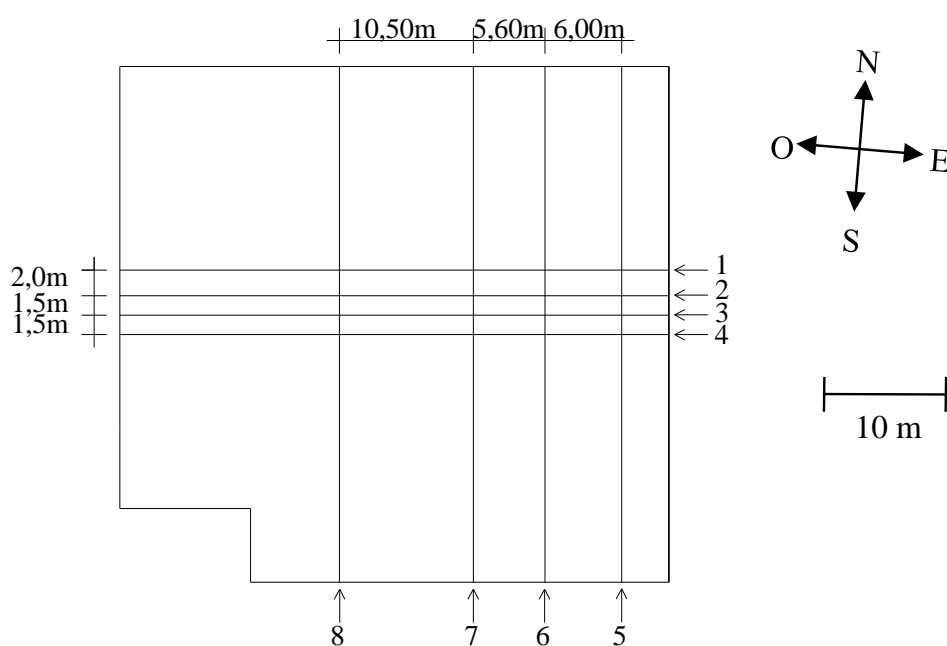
Localização perfis transversais (1 a 4) e longitudinais (5 a 8).
